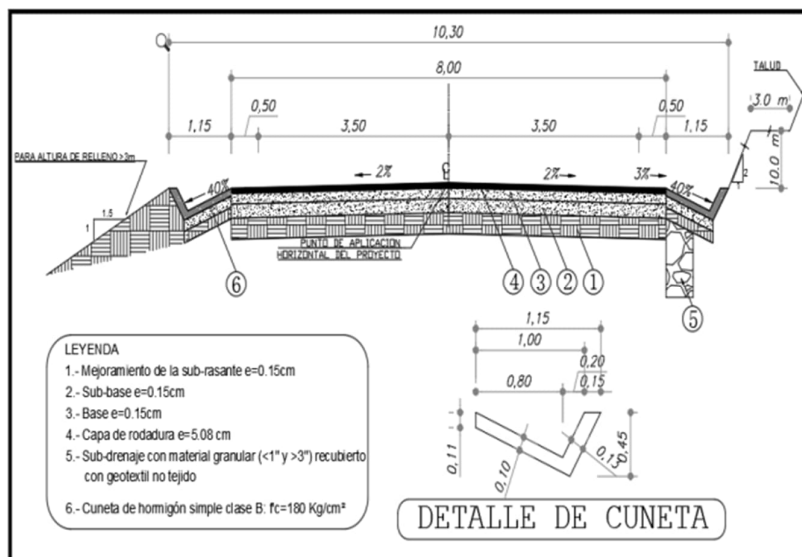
Sección Típica de capa de rodadura de concreto asfáltico para tramos 1 y 4.
